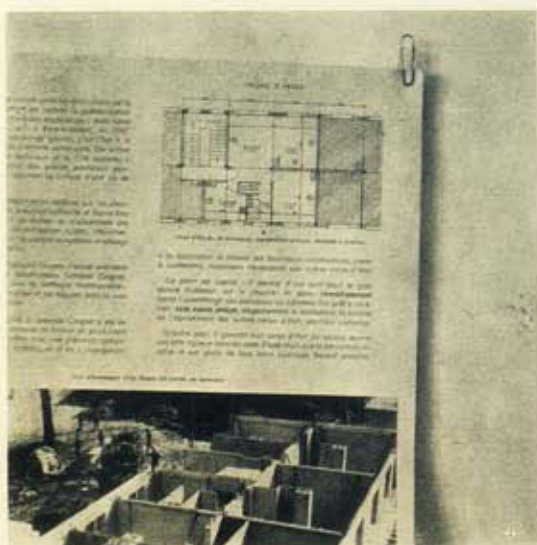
Planta das habitações em Evreux — 3 divisões soalhadas. O bloco tem 8,22 m. de largura. Os módulos são de 3,30 m.
